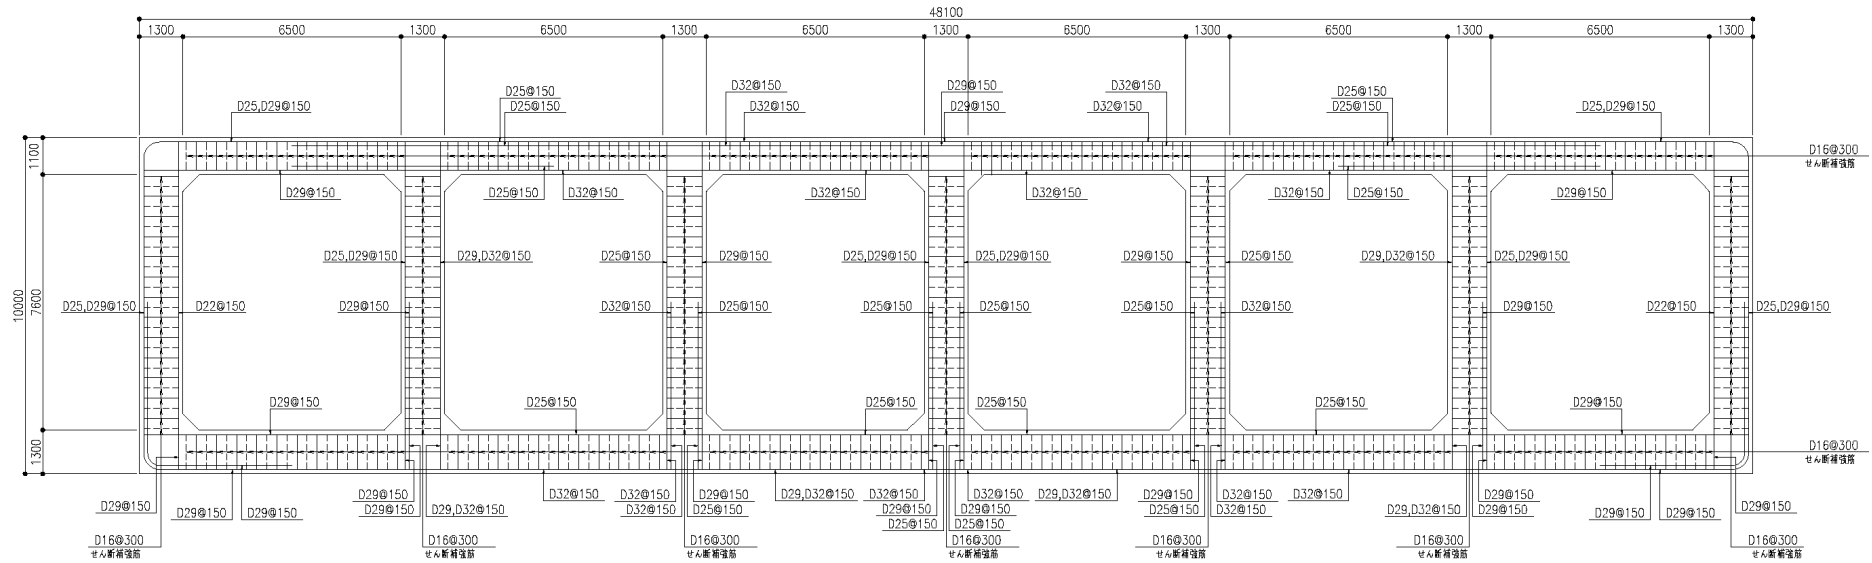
スクリーン室 (6号機設備) の概略配筋図 (A-A断面)
